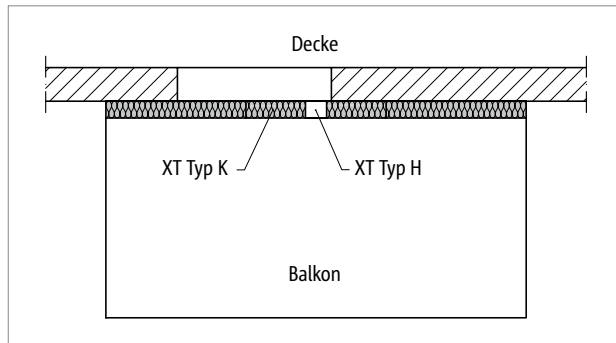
Schöck Isokorb® XT Typ K: Balkon frei auskragend; optional mit XT Typ H bei planmäßigen Horizontallasten (z. B. geschlossene Brüstungen)
